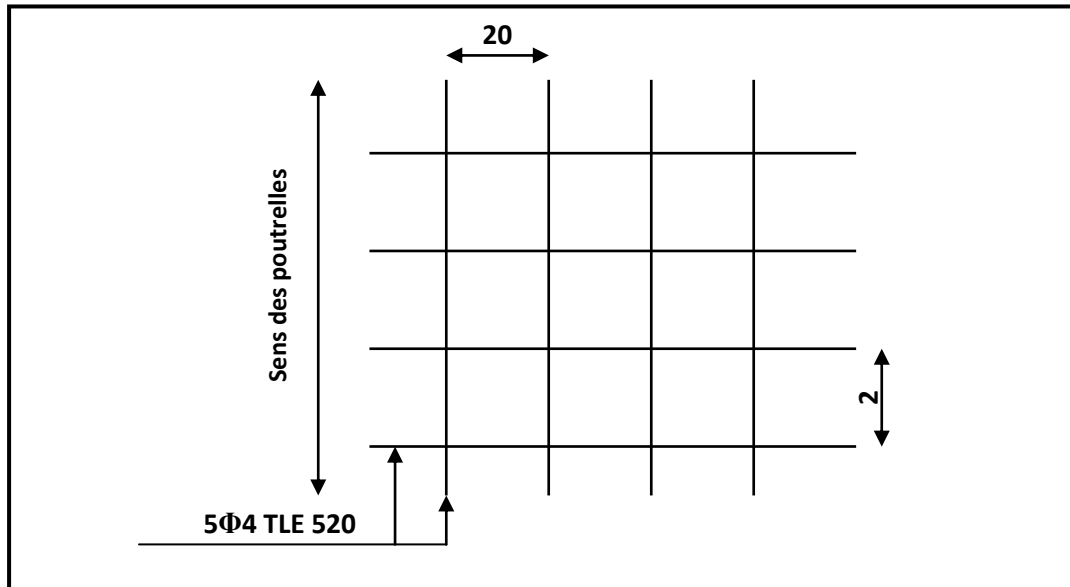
Ferrailage de la dalle de compression avec un treillis soudé 20x20 cm
